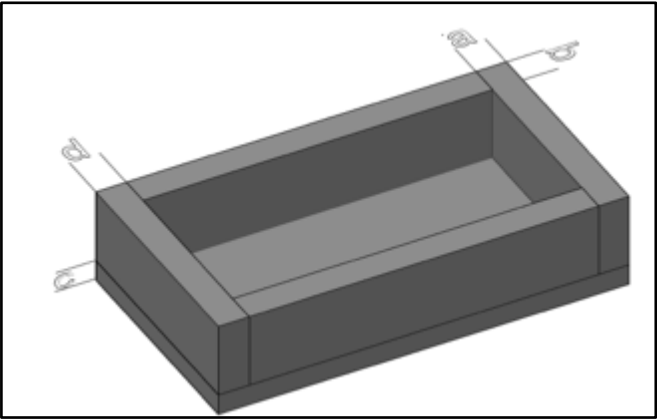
Caja de concreto con lleno. Fuente: Elaboración propia.
